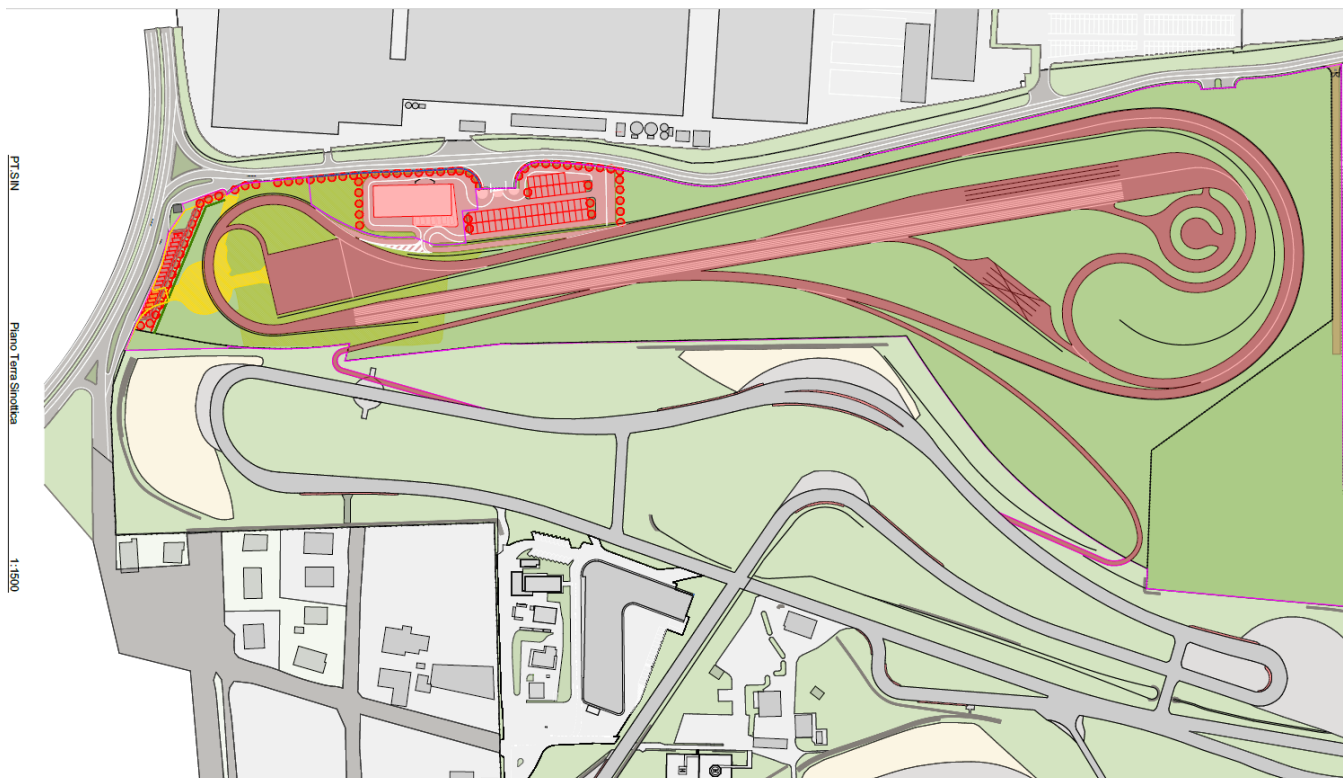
Planimetria della pista in progetto inserita all'interno del lotto di intervento
